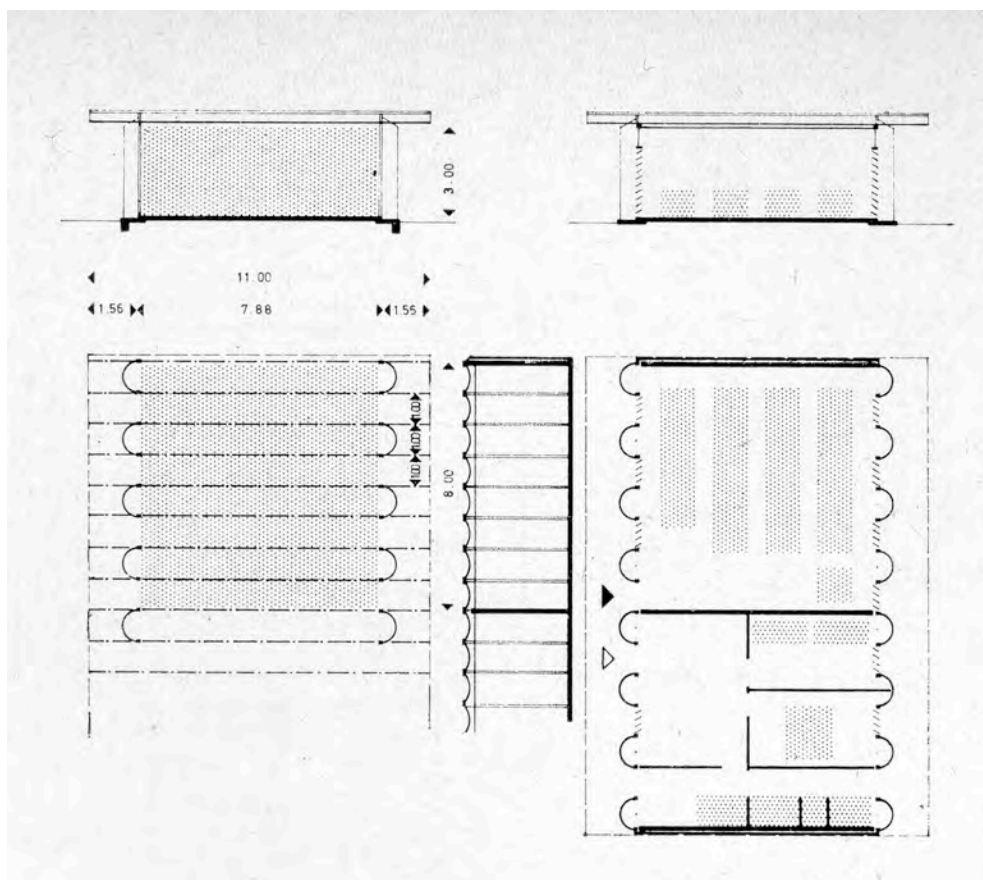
Entwurf für den Schulbauwettbewerb in Kamerun
